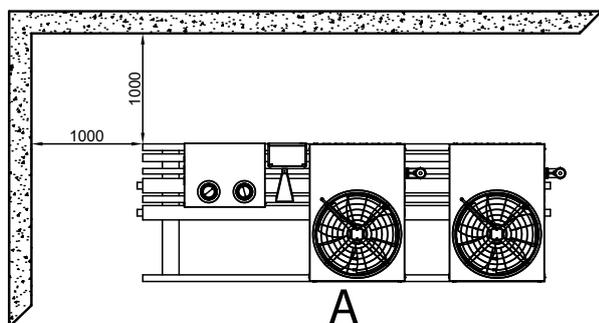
Distanze di rispetto singolo link aerotermico con 2 pareti più alte dell'apparecchio
